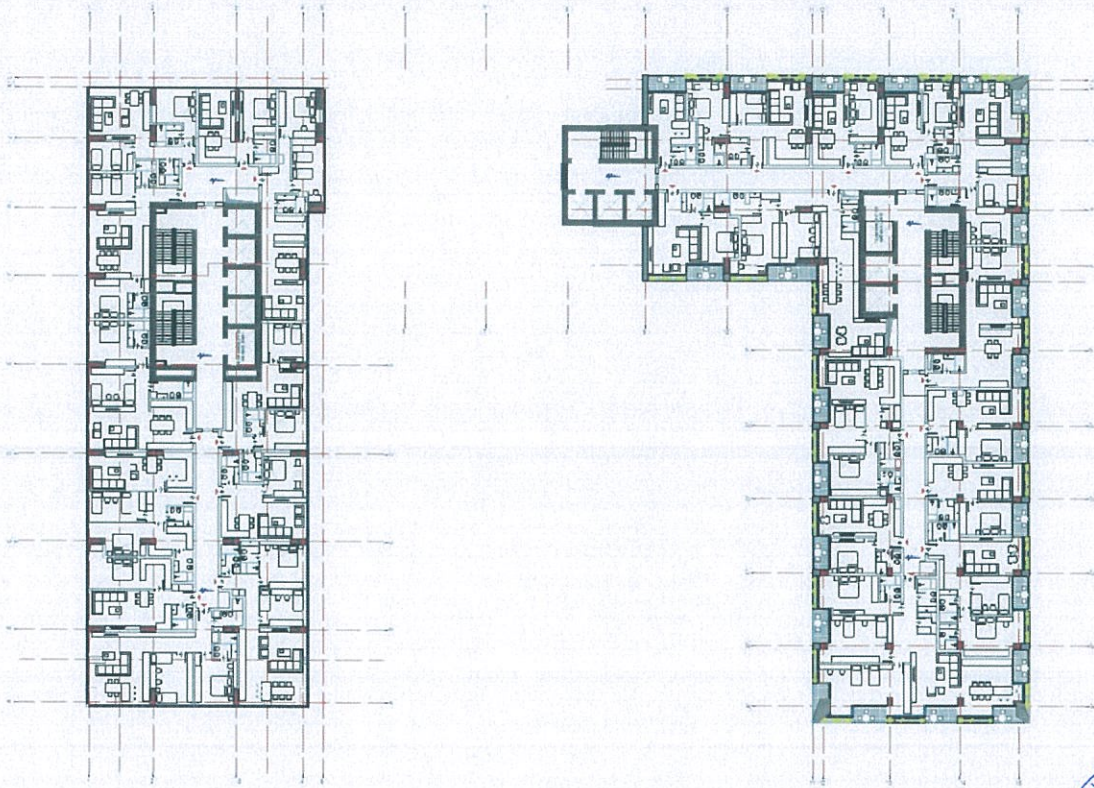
Planimetria e katit përdhe, në kuotën +0.00
